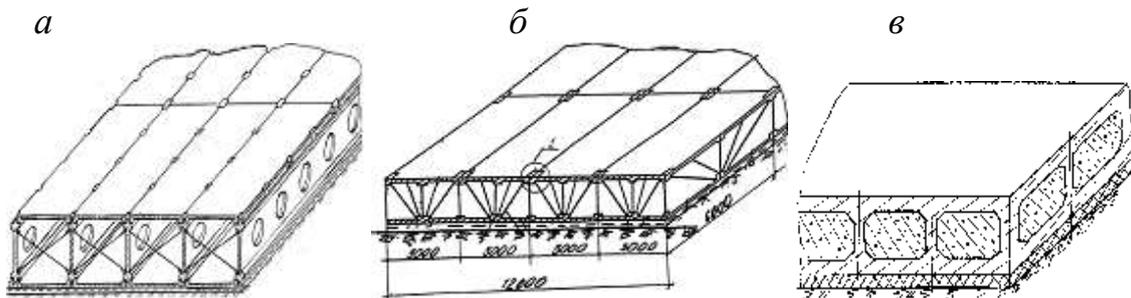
Пространственные фундаментные платформы для строительства на слабых и вечномёрзлых грунтах и в сейсмических районах: *а* – сборная железобетонная платформа (патент РФ № 38789); *б* – сборная сталежелезобетонная фундаментная платформа (патент РФ № 2206665); *в* – монолитная фундаментная платформа с утеплителем (патент РФ № 45410)
